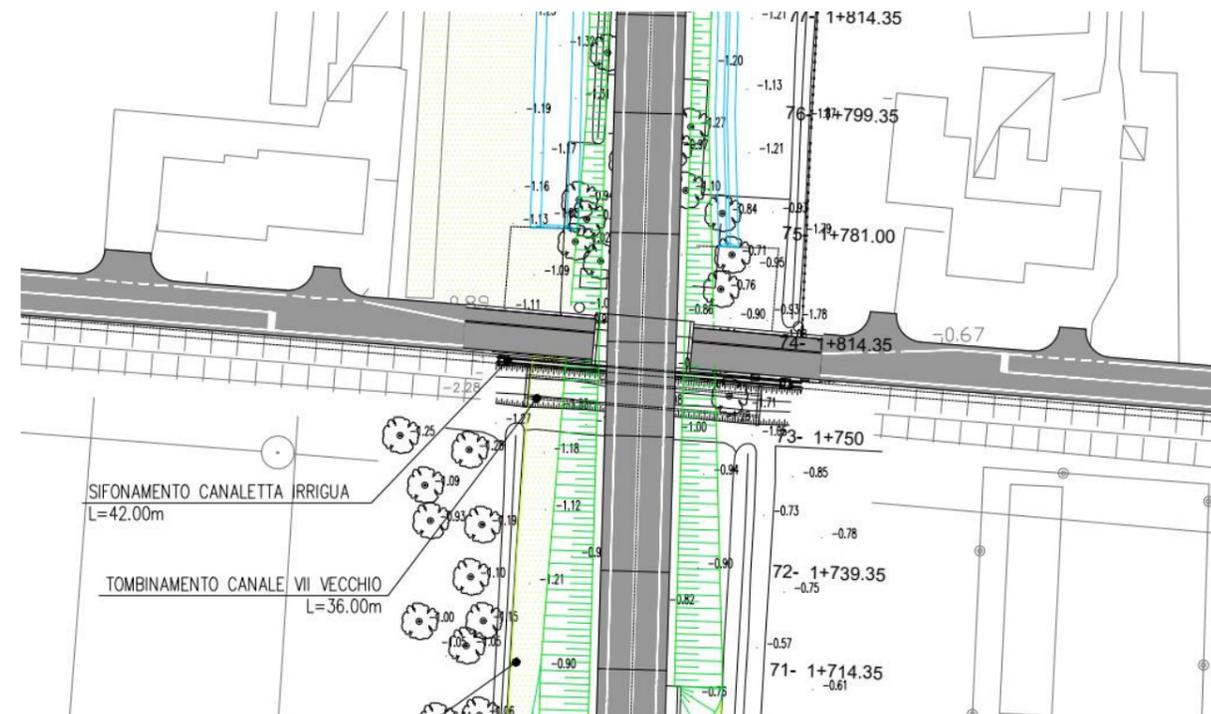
Stralcio planimetrico soluzione alternativa interferenza con il 3° ramo di via C. Colombo (dalla tavola di progetto 1370.0.F.E.008.2.D.0_Sottopasso via Colombo).
